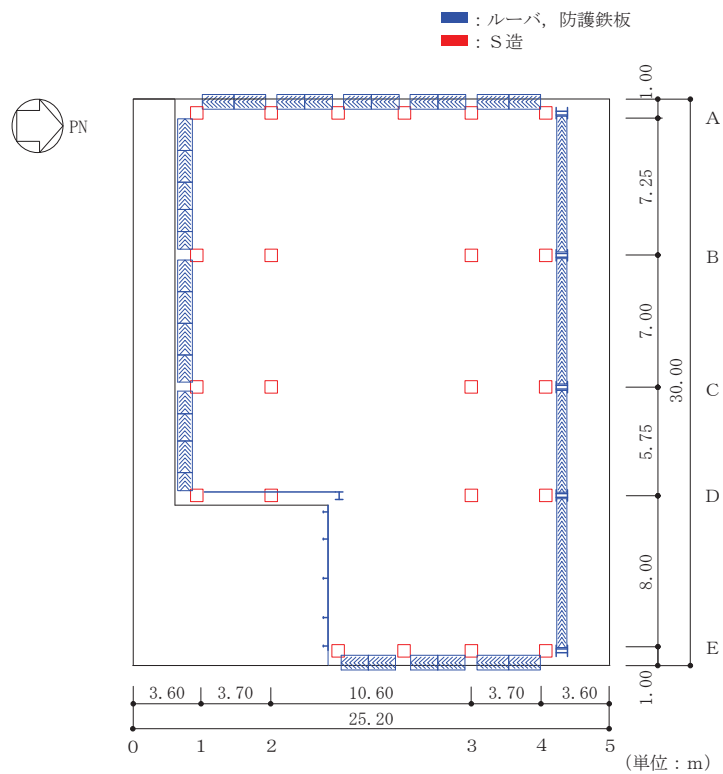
(2) 緊急用電気品建屋の概略平面図(0. P. 62.9 m)
